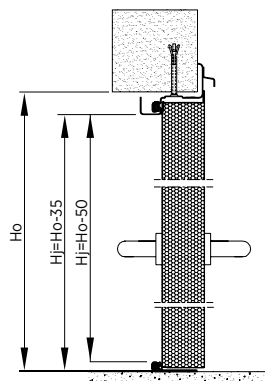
Pose au mur – bloc-porte à un vantail, bâti angulaire sans rupture de pont thermique – coupe verticale
